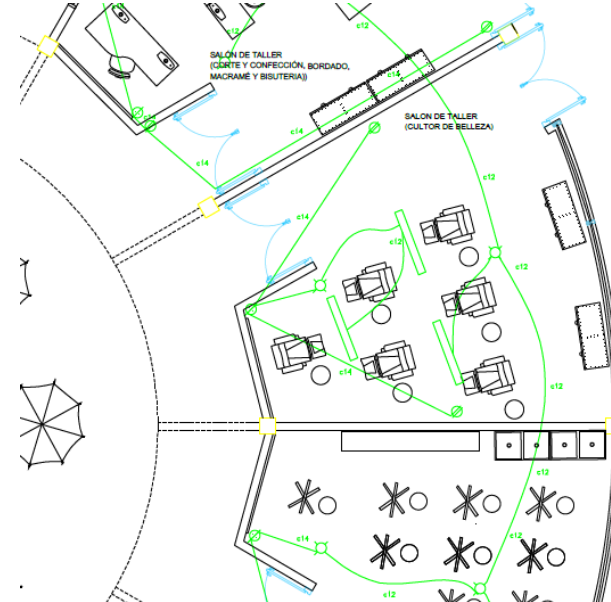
Detalle de Instalación eléctrica en Salón Taller.
